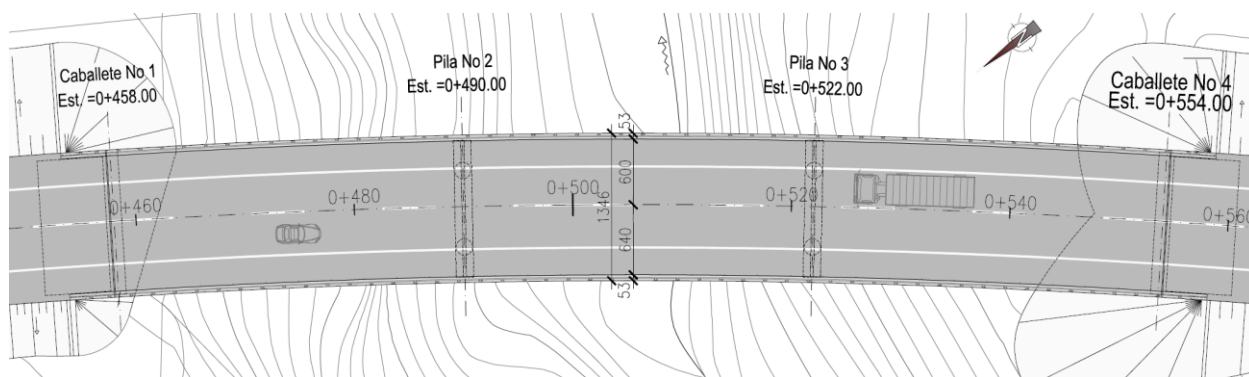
Planta de localização da Obra de Arte Especial 1 em análise.
